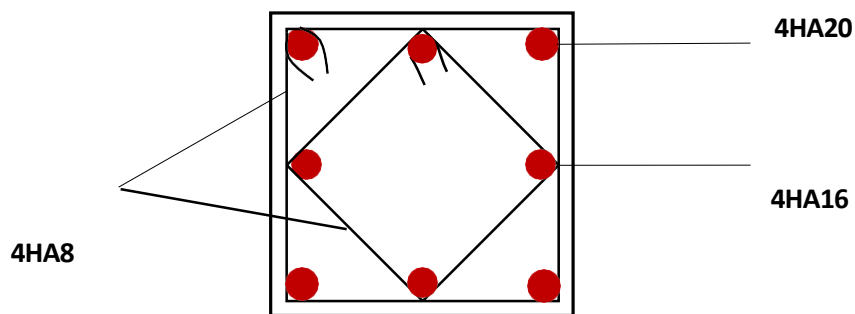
Schéma de ferrailage du poteau 45x45.
